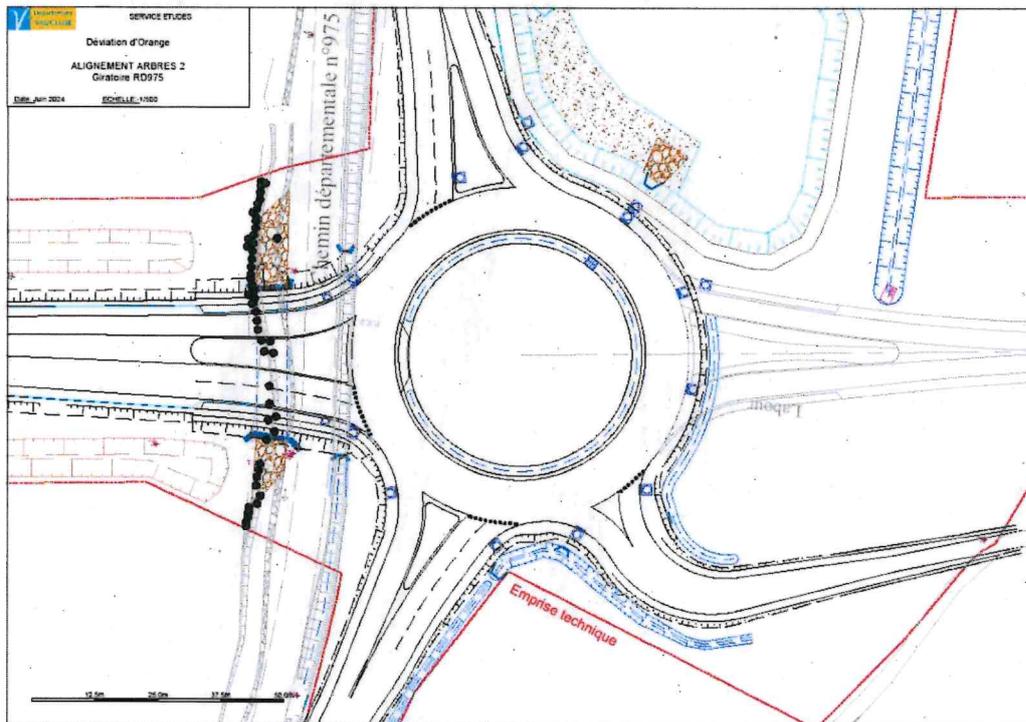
Plan du giratoire de RD975 - alignement 2 (Source: CD84)
